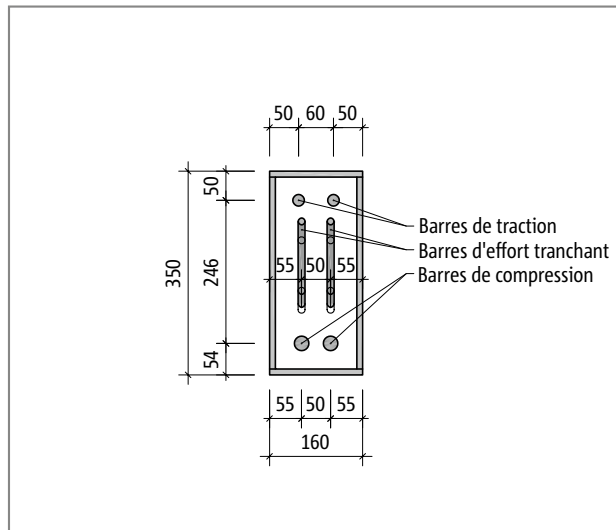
Schöck Isokorb® T Type B-M1-V1 en hauteur H350 : Vue du produit
